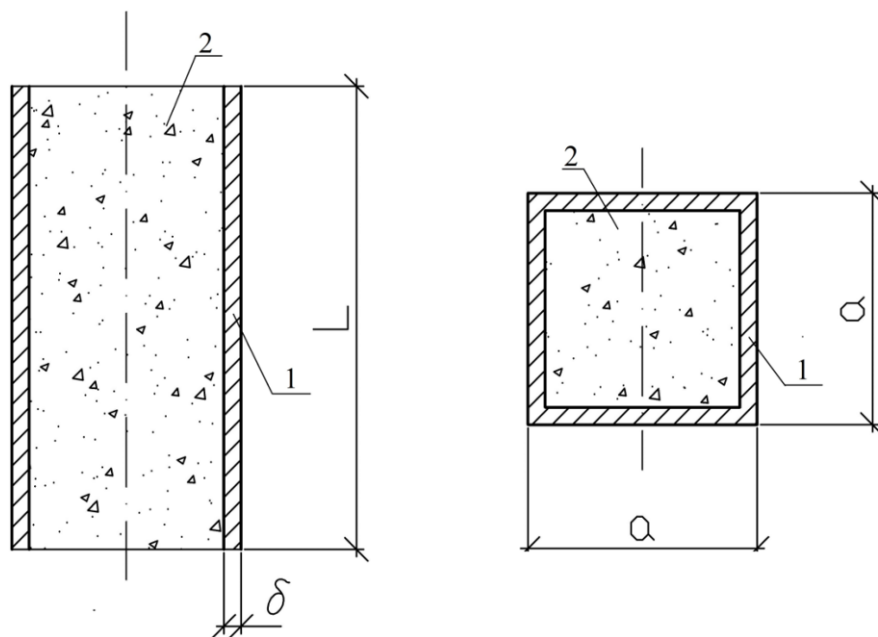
Розрахункова схема сталобетонної колони: 1 - сталева обойма; 2 - бетонне ядро
